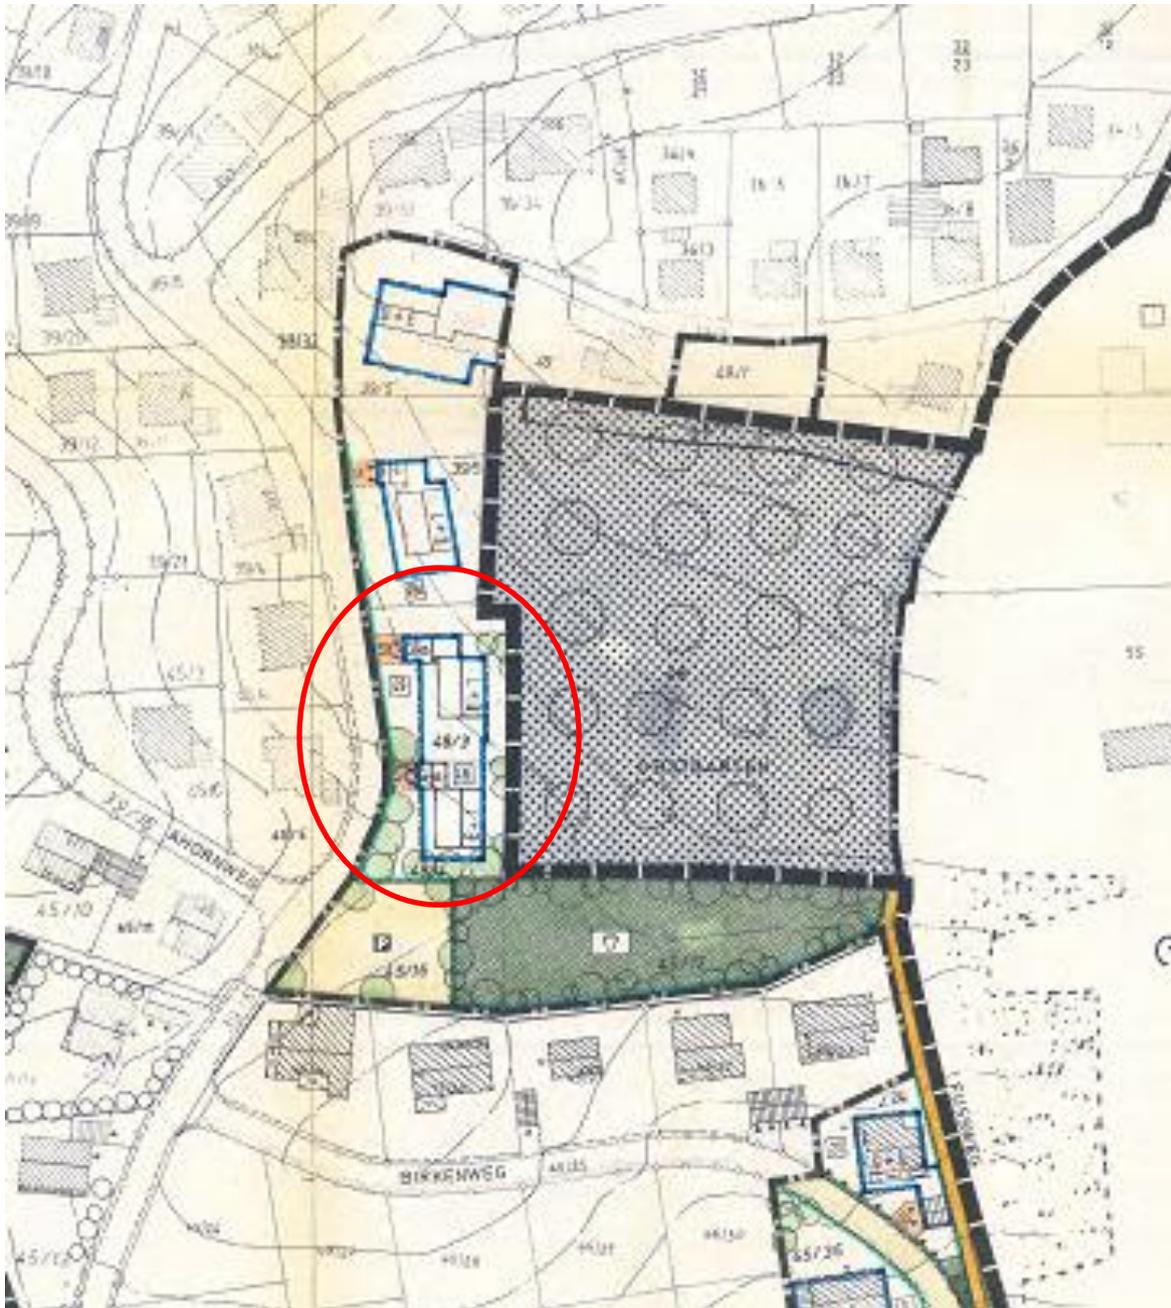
Rechtskr Bebauungsplan „Jägerhölzl“ DB 1, maßstabslos
